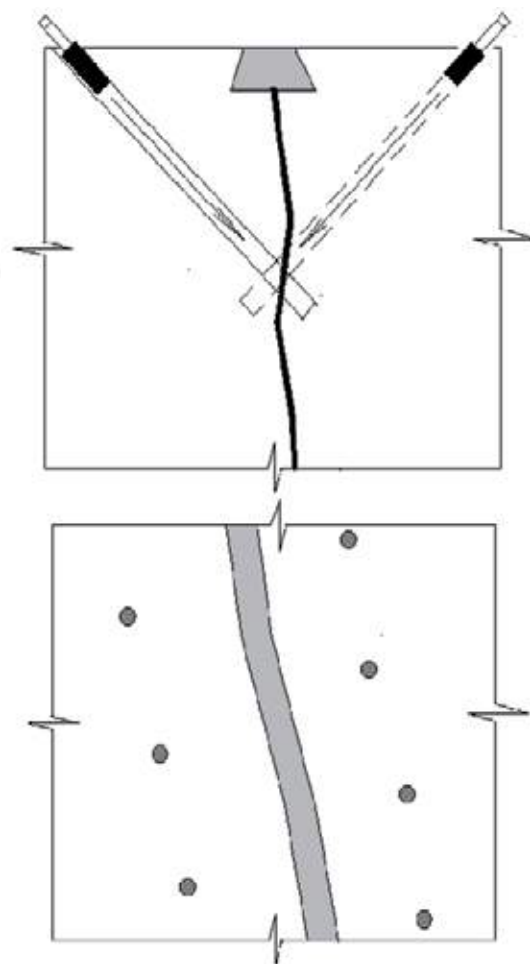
Схема инъектирования участка фундамента с трещиной (разрез и план участка фундамента)
